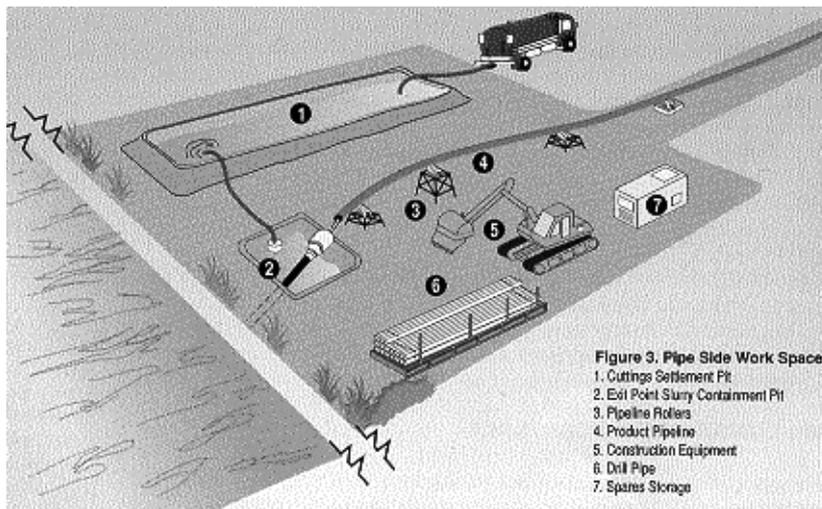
Baustelleinrichtung am Zielpunkt: Ansatzpunkt für Aufweitungsbohrköpfe und Einziehen des Rohrstrangs [3]
